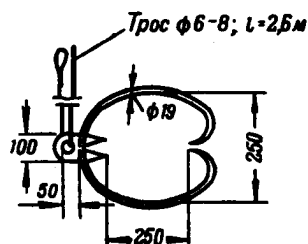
Кошка для крепления насадки к крайним сваям опоры.
